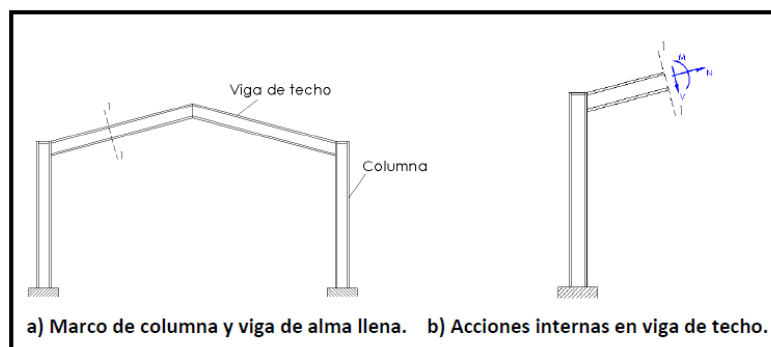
Viga de alma llena en un marco (Crissafulli, 2013)
